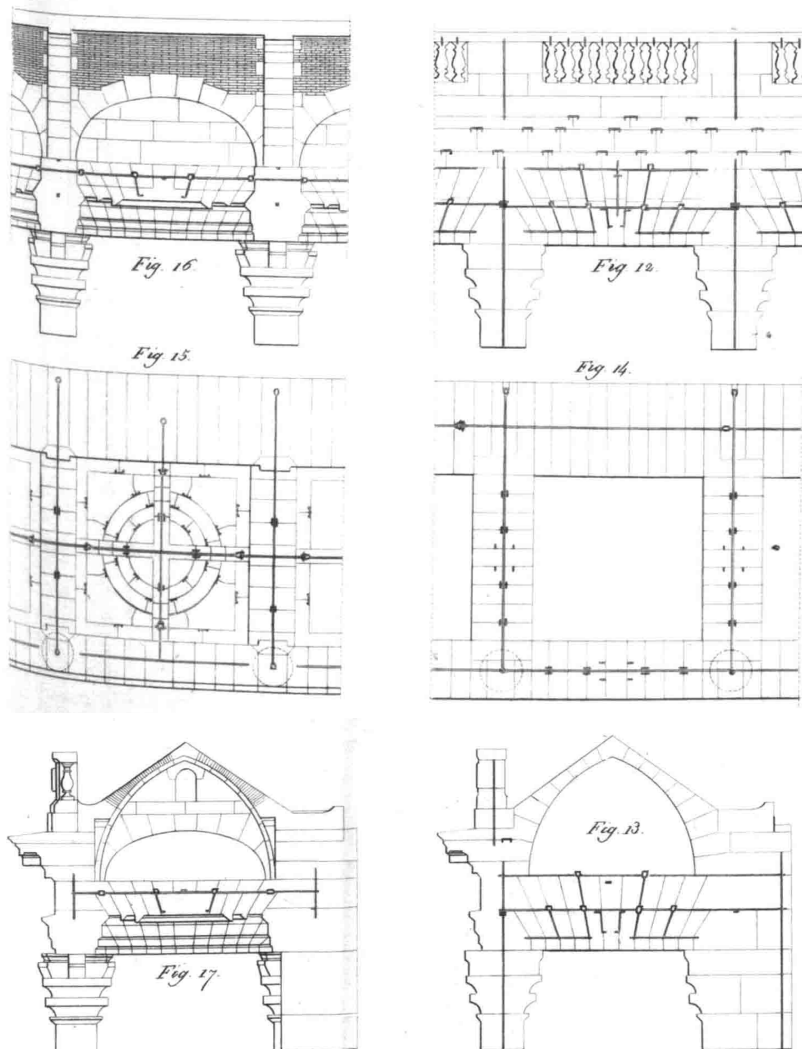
Costruzione delle doppie piattabande armate costruite in diversi peristili costituenti i colonnati della piazza Louis XV a Parigi; piante e sezione⁴⁶.
